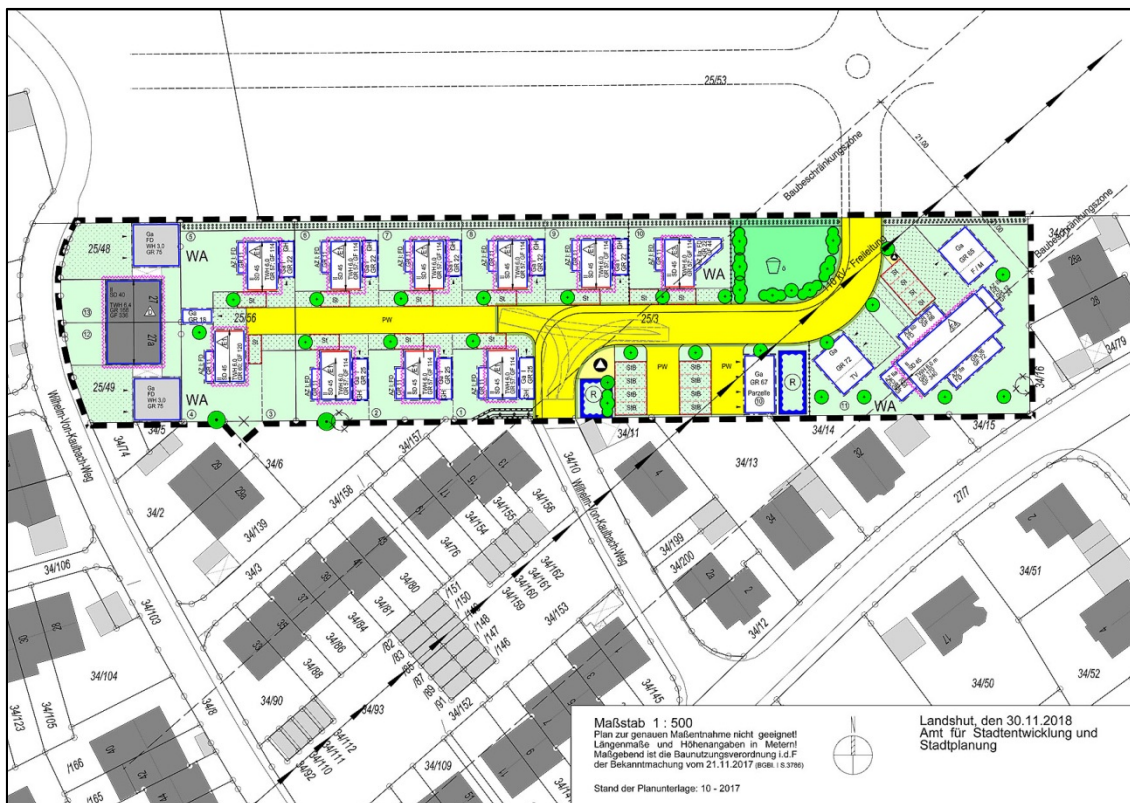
Planzeichnung zum Bebauungsplan Nr. 10-83/2 "Nördlich Wilhelm-von-Kaulbach-Weg" der Stadt Landshut /11/
